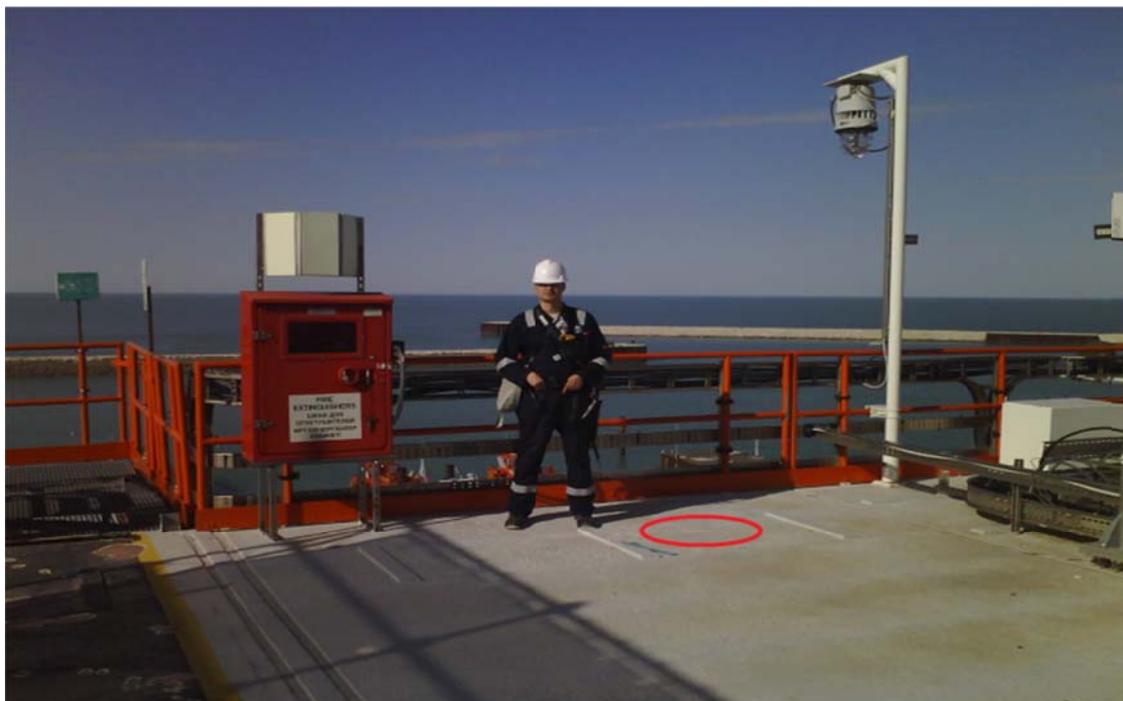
2. Место установки конструкции под видеокамеры.
